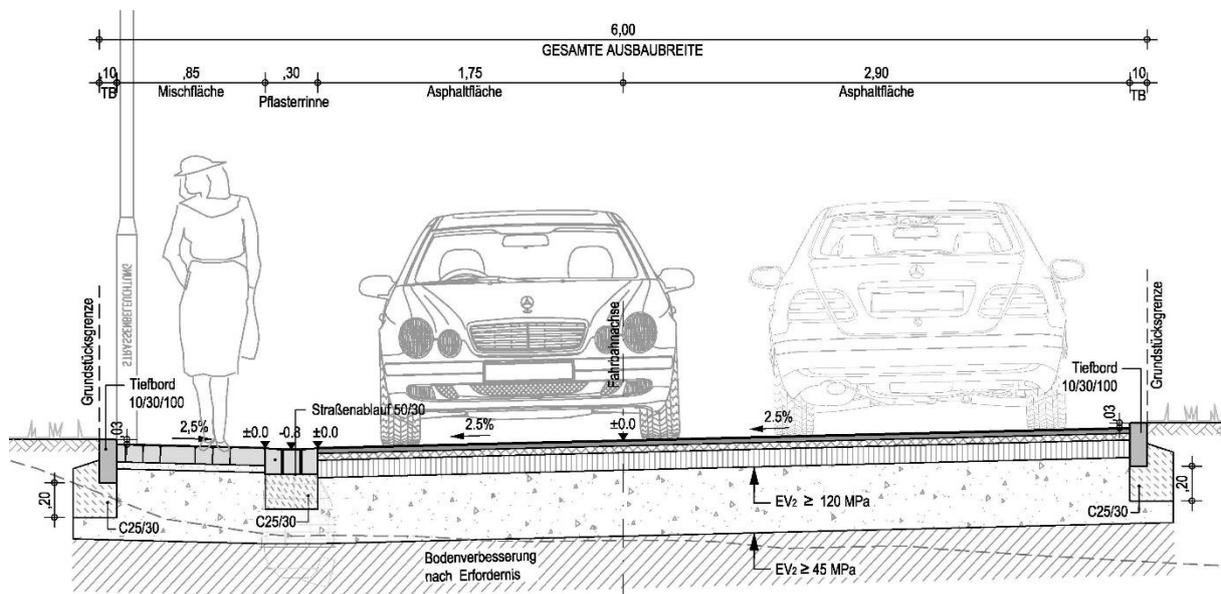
Regelquerschnitt der Erschließungsstraße (Auszug aus der Fachplanung, Ingenieurbüro Falkenhahn & Partner, Stand 21.04.2020)
